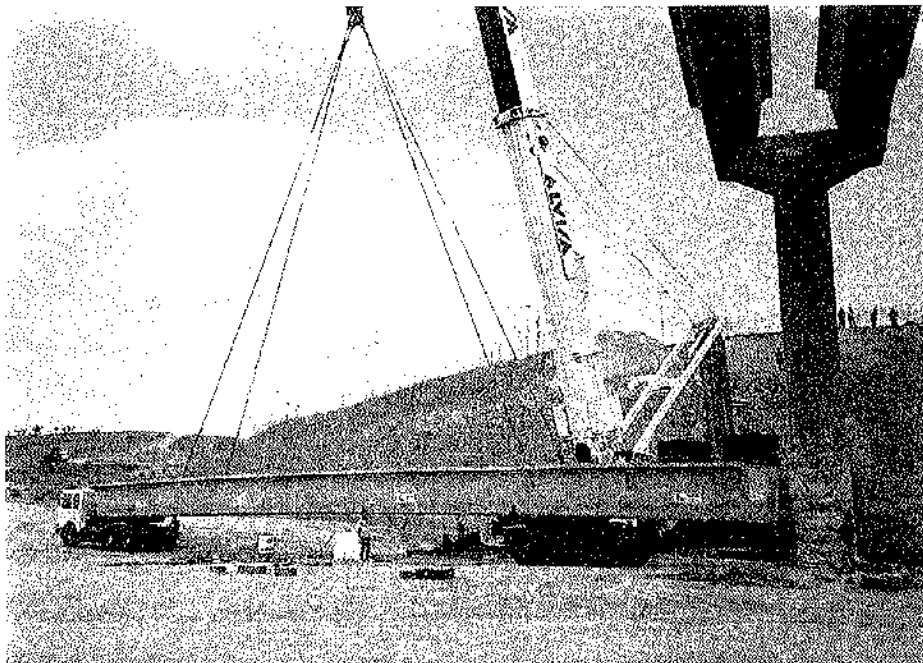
Puente de acceso a los Recintos FERIALES de Madrid. Vigas-artesa de  $L \leq 39$  m. Pílas prefabricadas.
